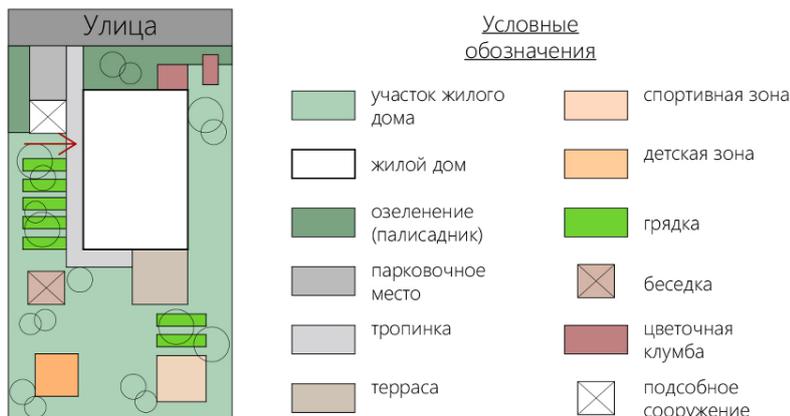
Схема функционального зонирования генерального плана участка жилого дома
